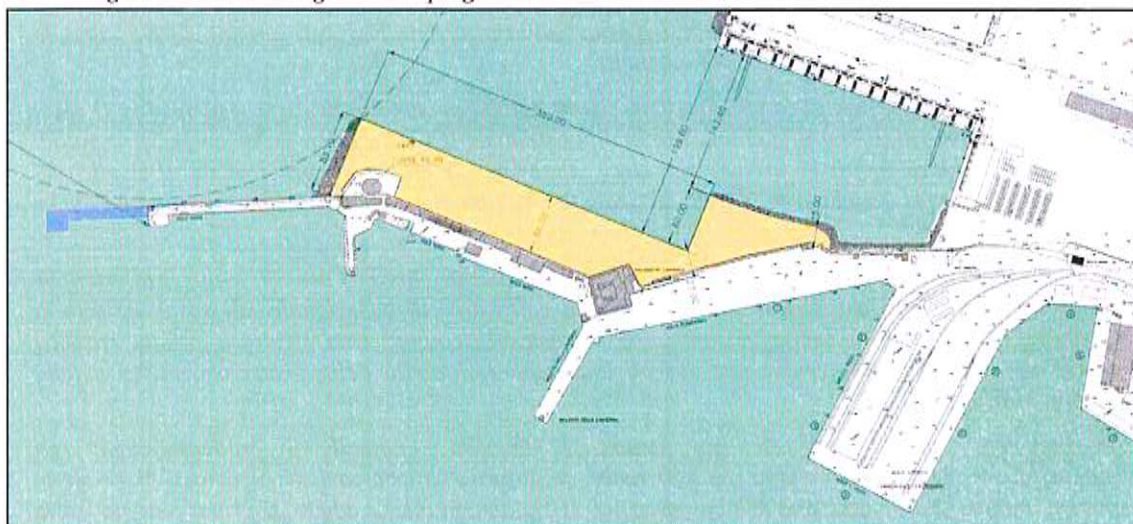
Planimetria generale di progetto SOLUZIONE 2 con retrobanchina.
